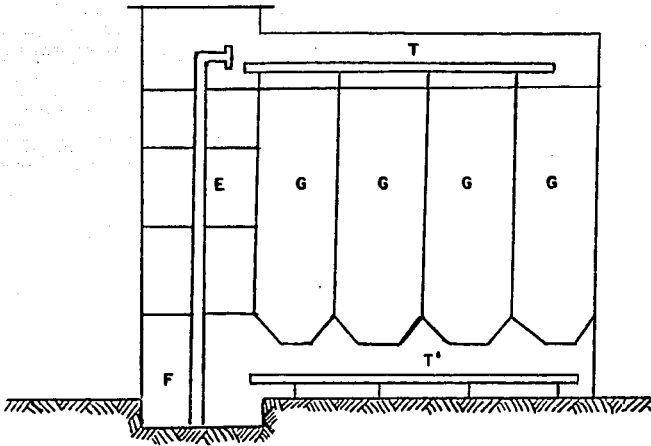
BATERÍA DE SILOS SOBRE COLUMNAS DE CONCRETO
